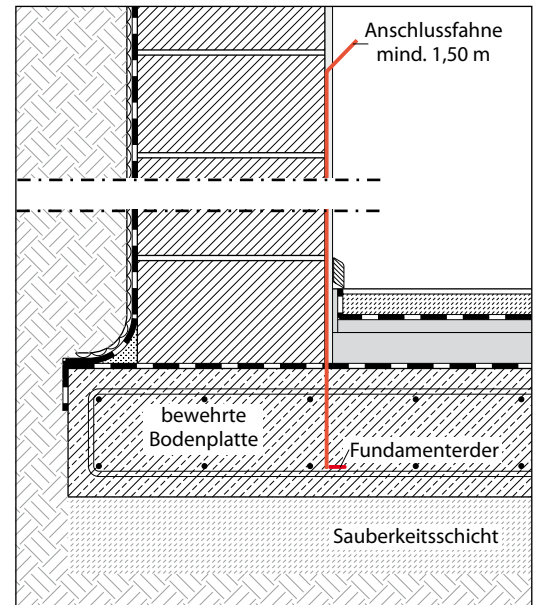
Ausführung des Fundamenterders in bewehrtem Fundament
